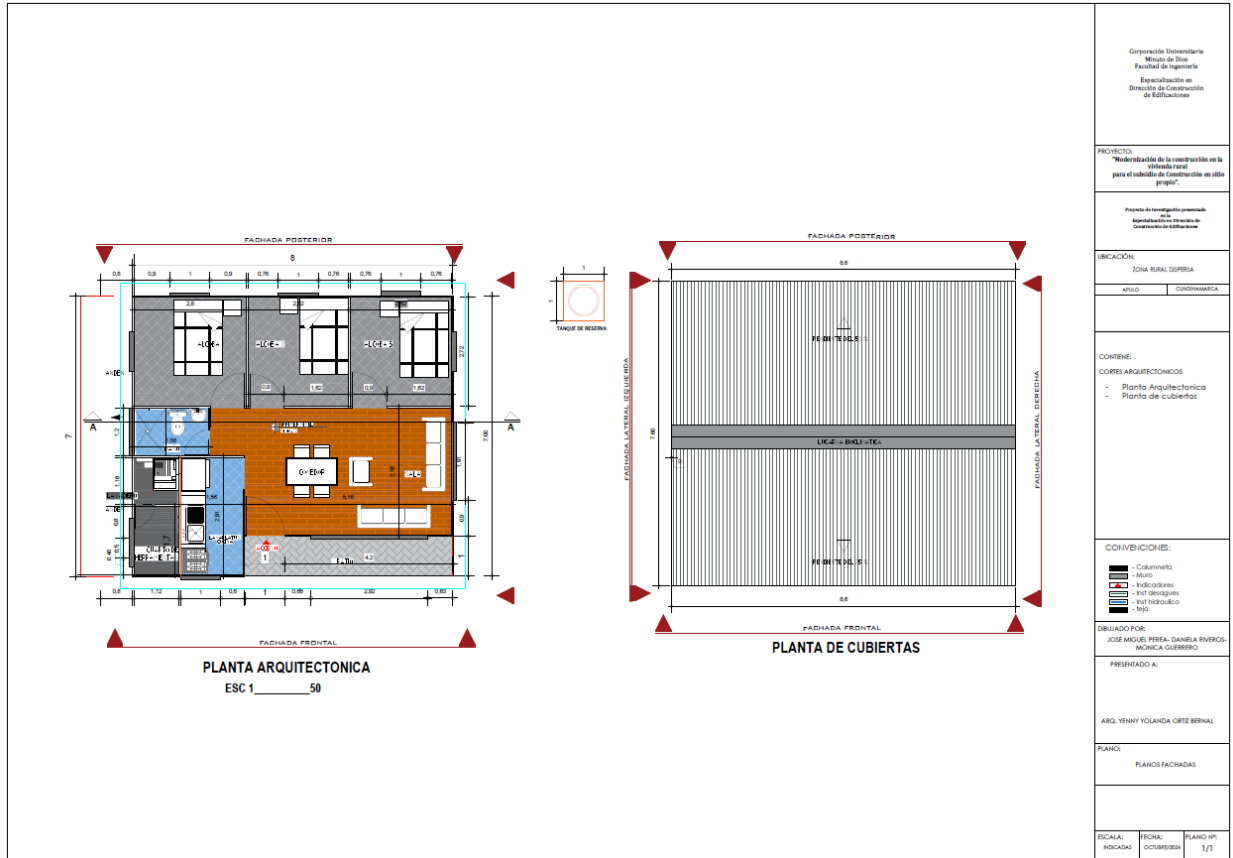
Plano fachadas. Fuente: Autores, 2024.
